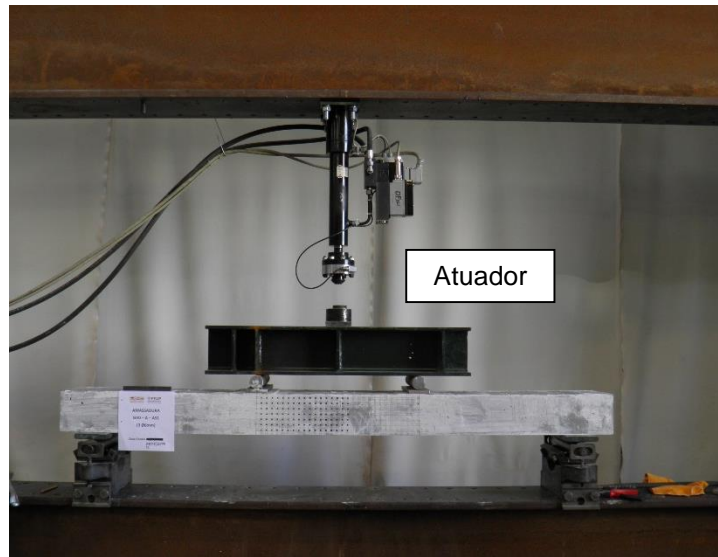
Esquema de montagem da viga e posição do atuador
